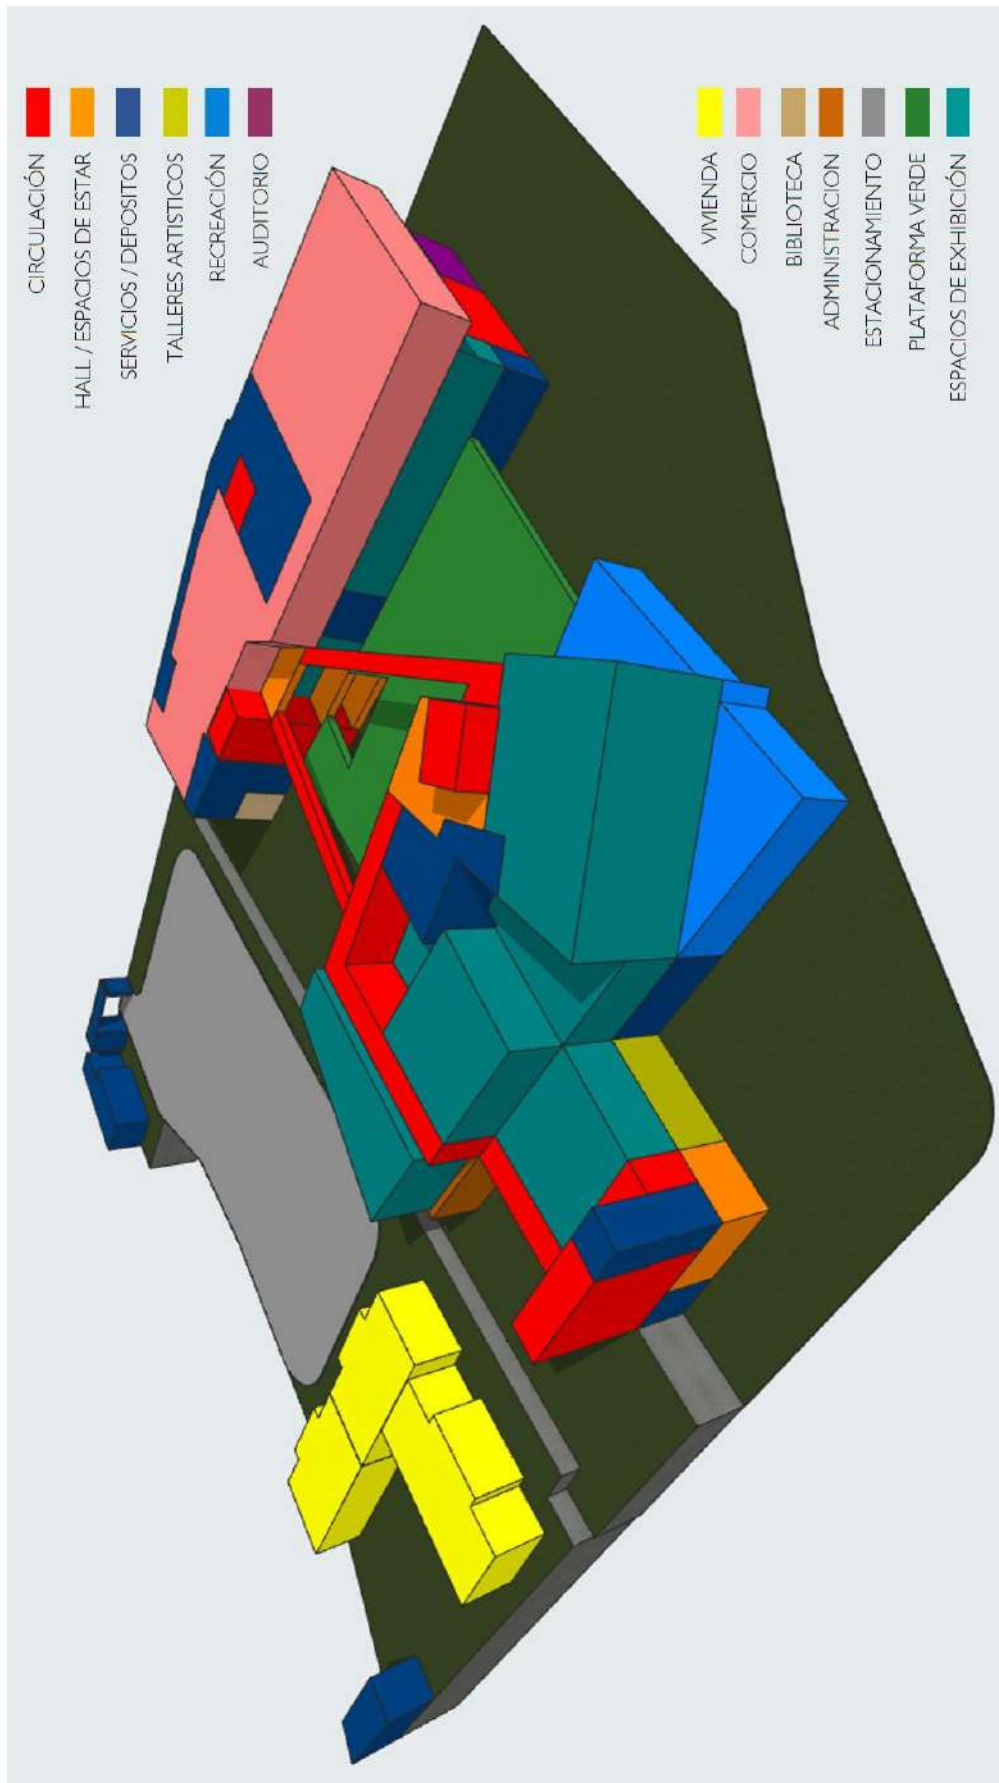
Esquema 3D zonificado del conjunto arquitectónico.
